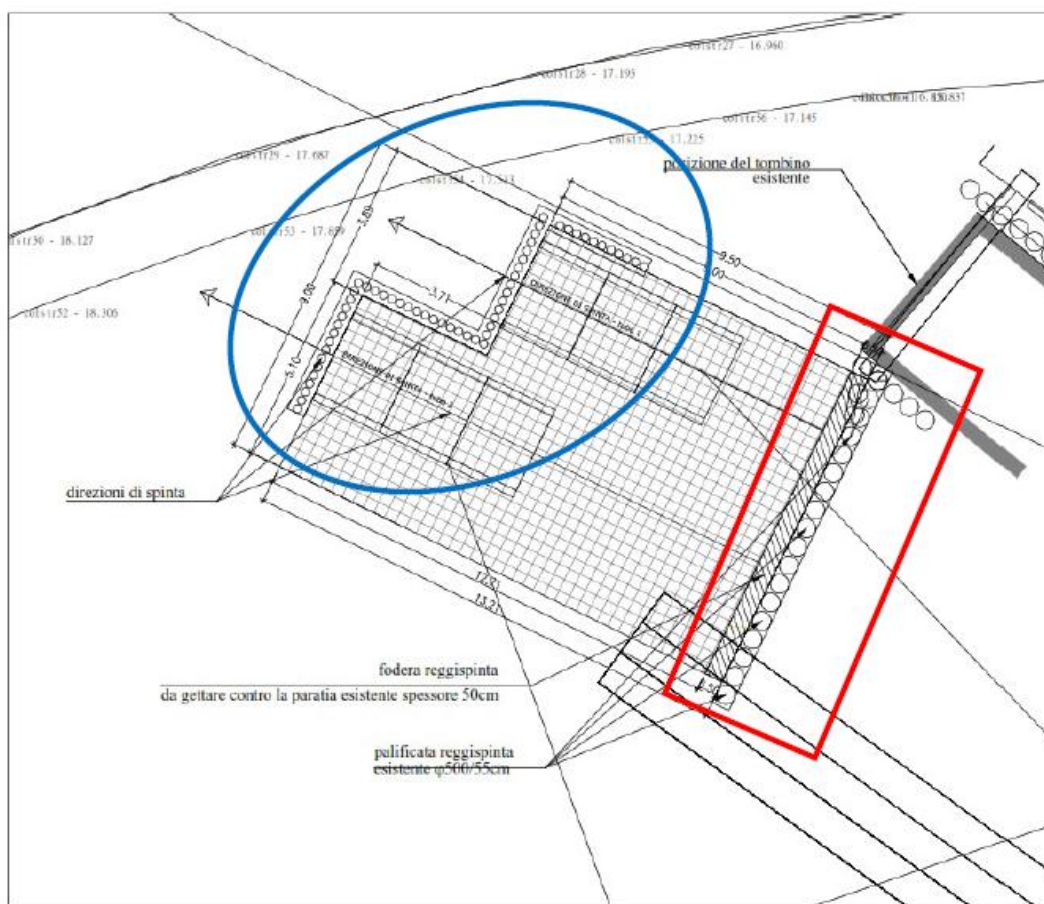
| Stralcio Planimetrico Generale – Struttura esistente.
